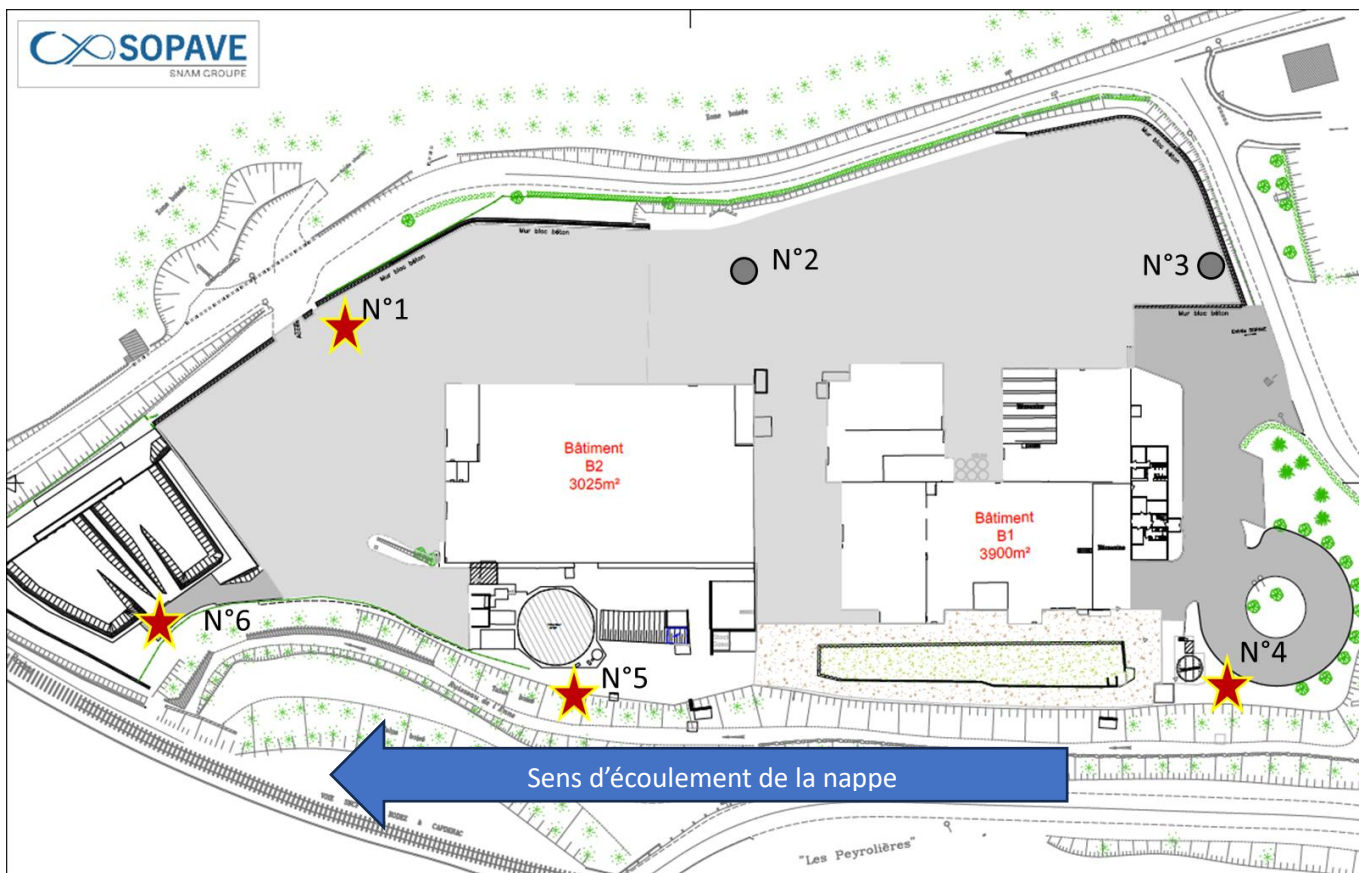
Plan d'implantation des points de prélèvement de la matrice « eaux souterraines »
